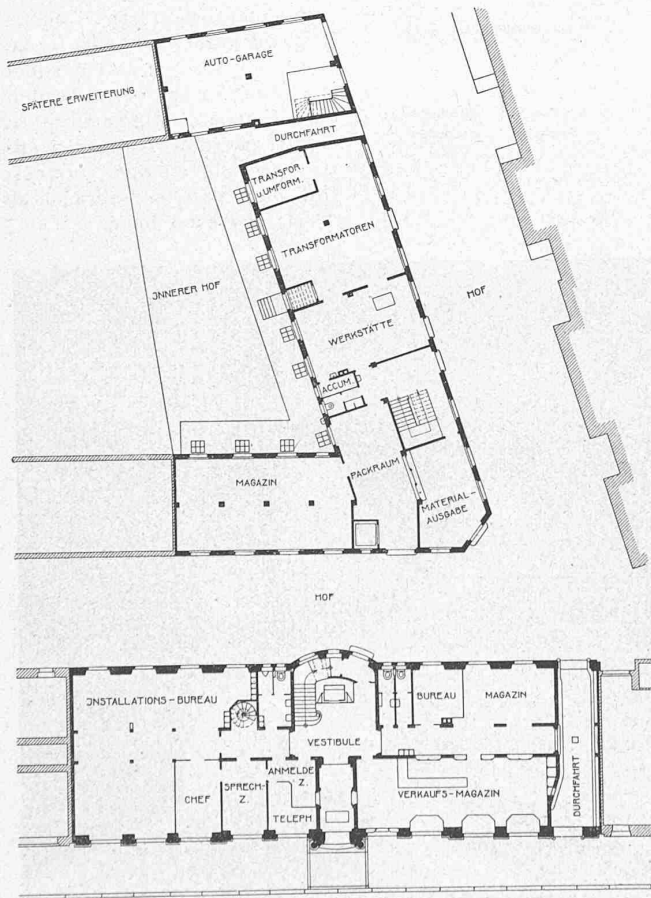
Erdgeschoss-Grundriss des Haupt- und des Hintergebäudes. — 1 : 500.
